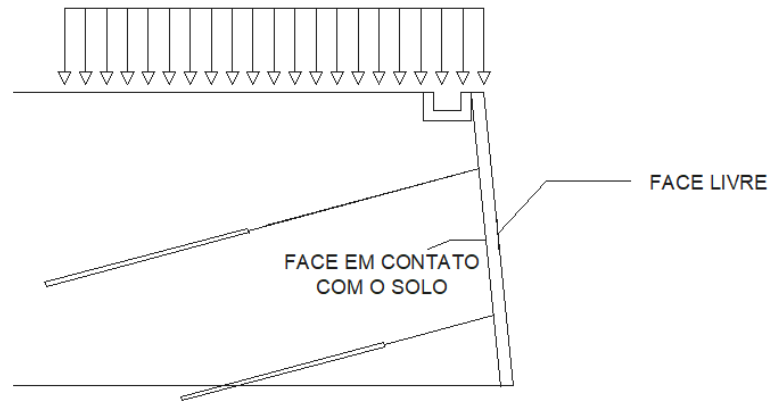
Faces da laje de concreto armado onde serão distribuídas as armaduras.
